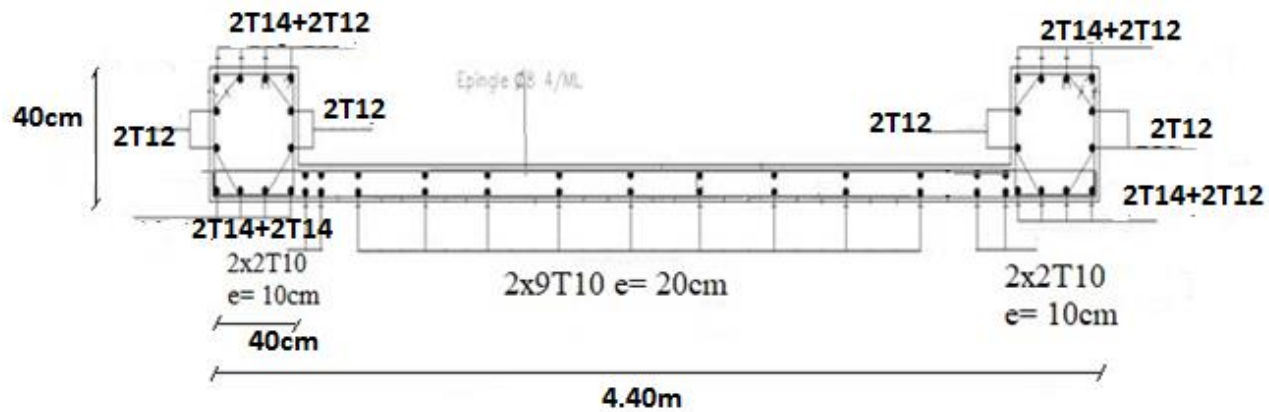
Schéma de ferrailage du voile en S4 sous forme U.
